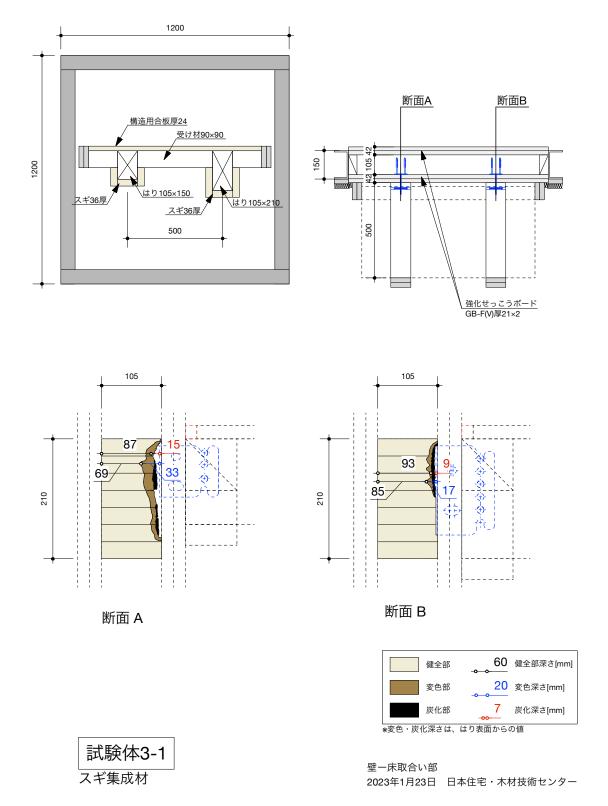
試験体 3-1 炭化図(単位:mm) ※梁受け金物を取り付けるために元々4mm 深さで座掘りされている
